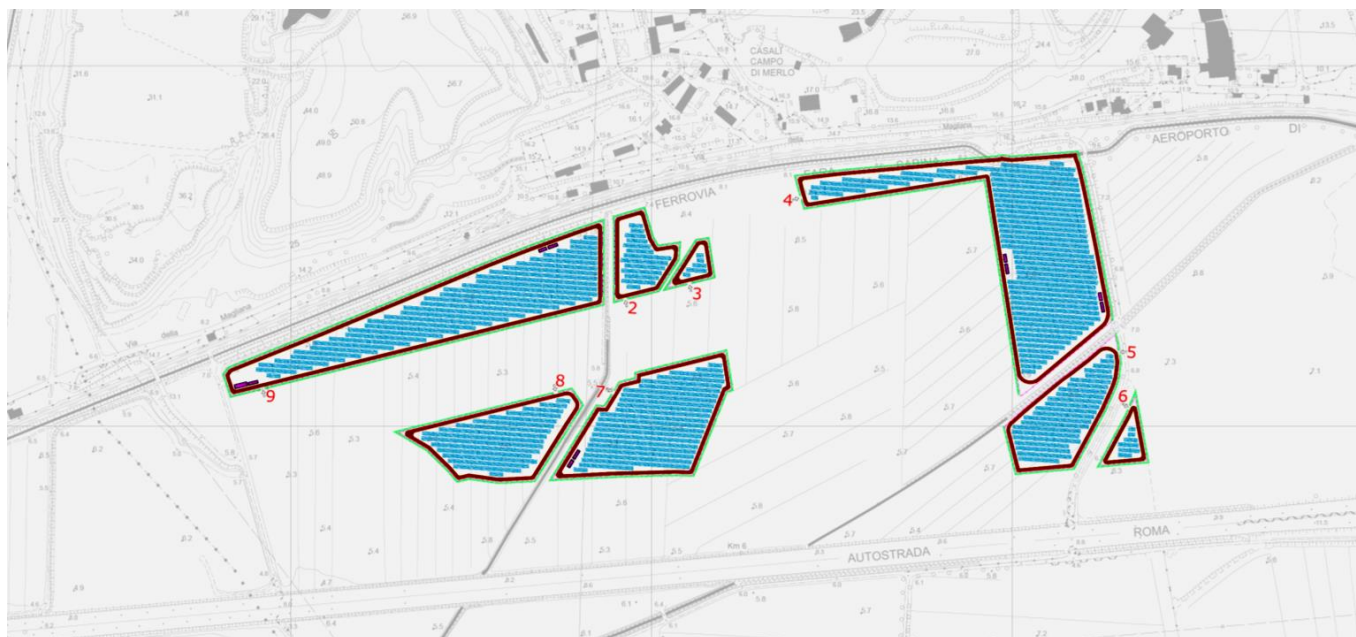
Layout Impianto LOTTO 1 (non ricadente in area a rischio idraulico)
